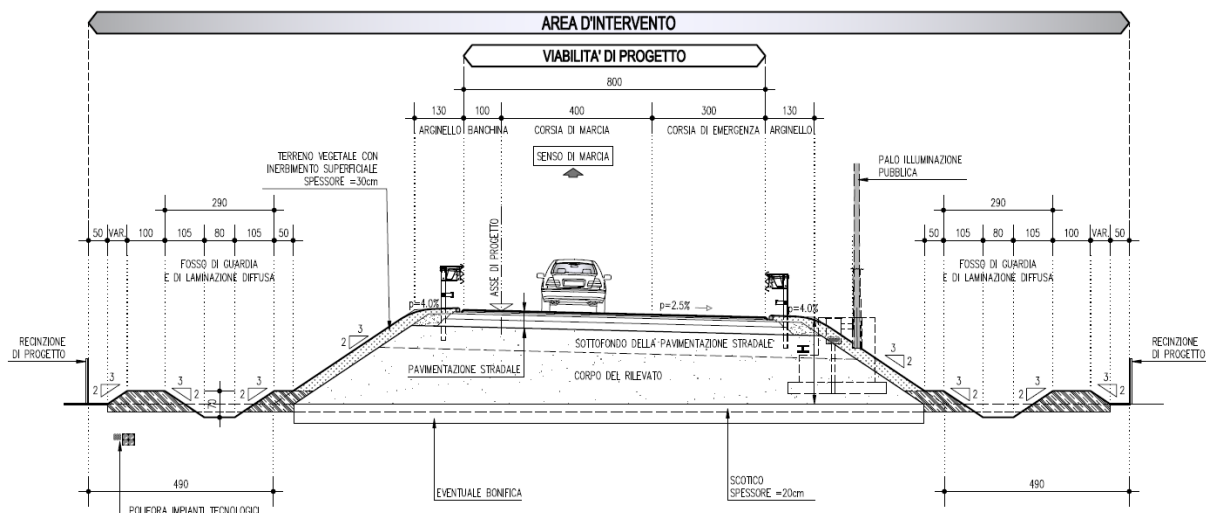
SEZIONE TIPO RAMO DI SVINCOLO UNIDIREZIONALE AD UNA CORSIA (RILEVATI H≤7M)
